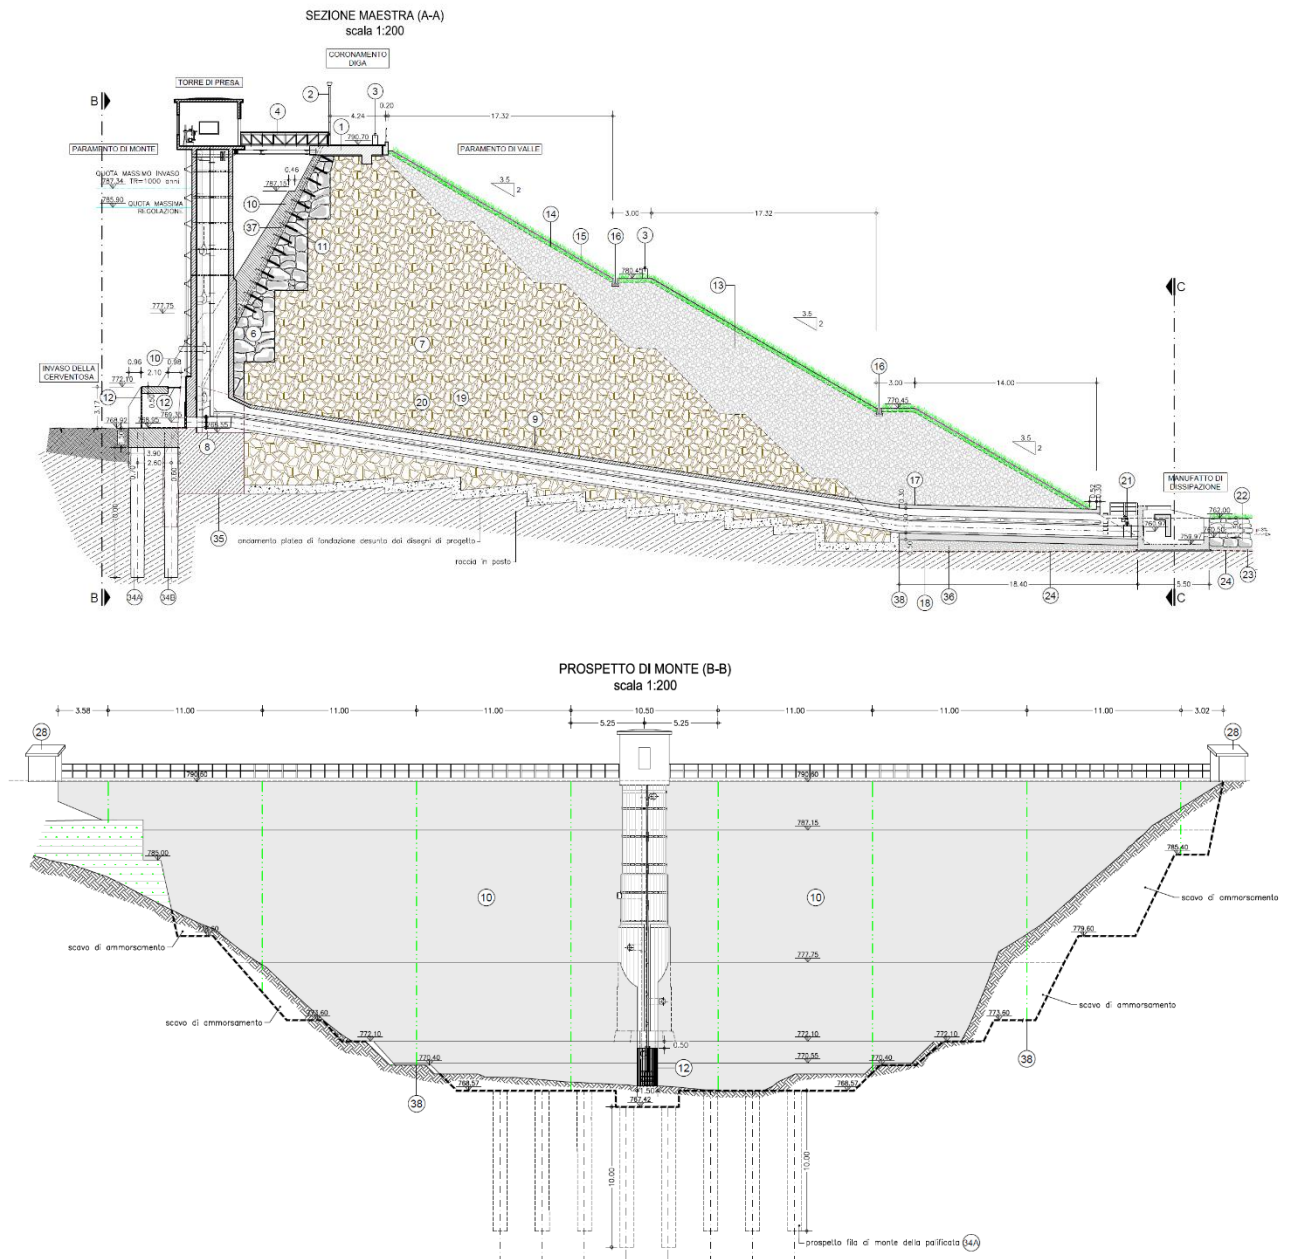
Stato di progetto: sezione maestra e prospetto del paramento di monte
